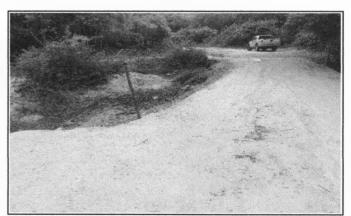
LOCAL DA CONSTRUÇÃO - BUEIRO CAPEADO
